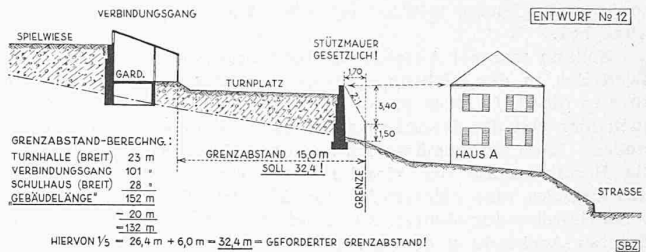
bis 3. Lageplan 1 : 4000, Bild und Profil 1 : 600 zu Entwurf Nr. 12
